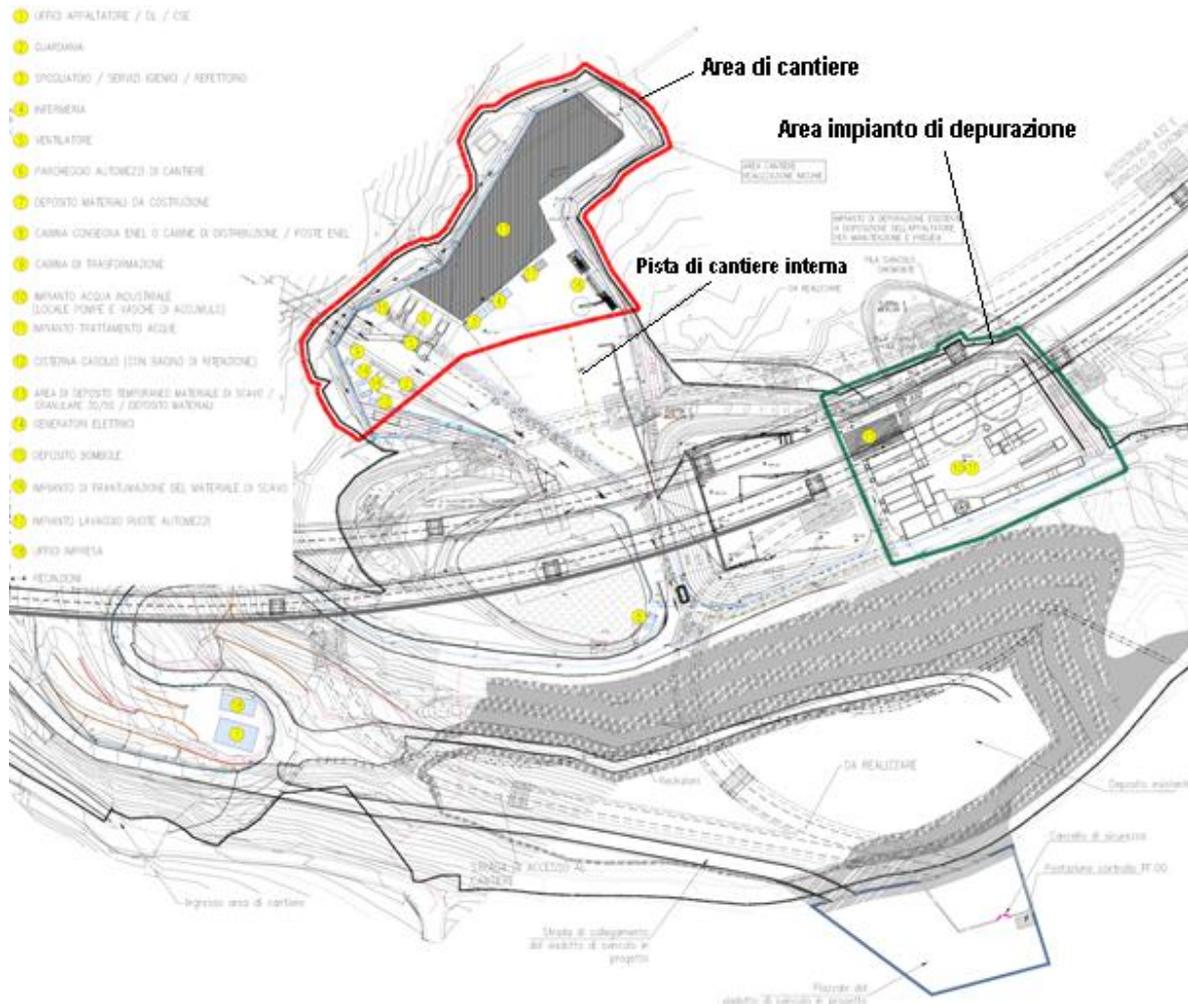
Planimetria area cantiere e impianto di depurazione in corrispondenza dell'imbocco
